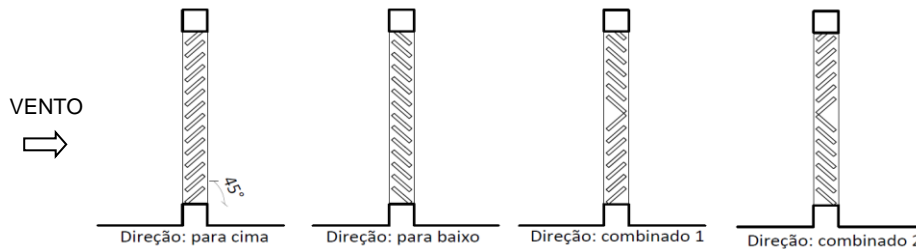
Cortes demonstrando as configurações do muro vazado com lâminas horizontais com inclinação de 45°.
